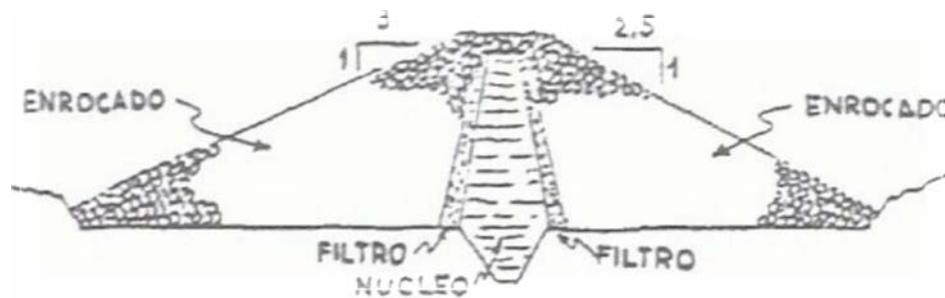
Presa heterogénea con núcleo delgado [3]
